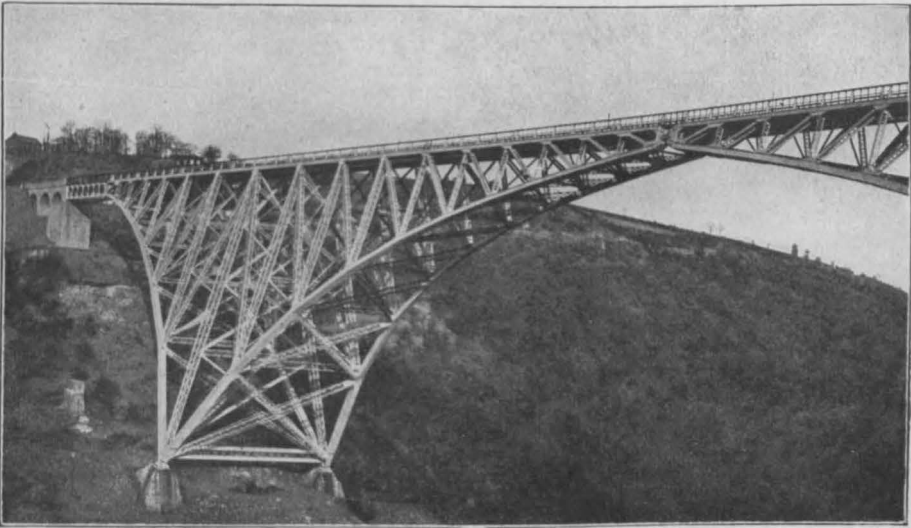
Eisenbahnbrücke über den Viaurfluß. Linie Carmaux-Rodez (Südfrankreich). 1896—1902.
